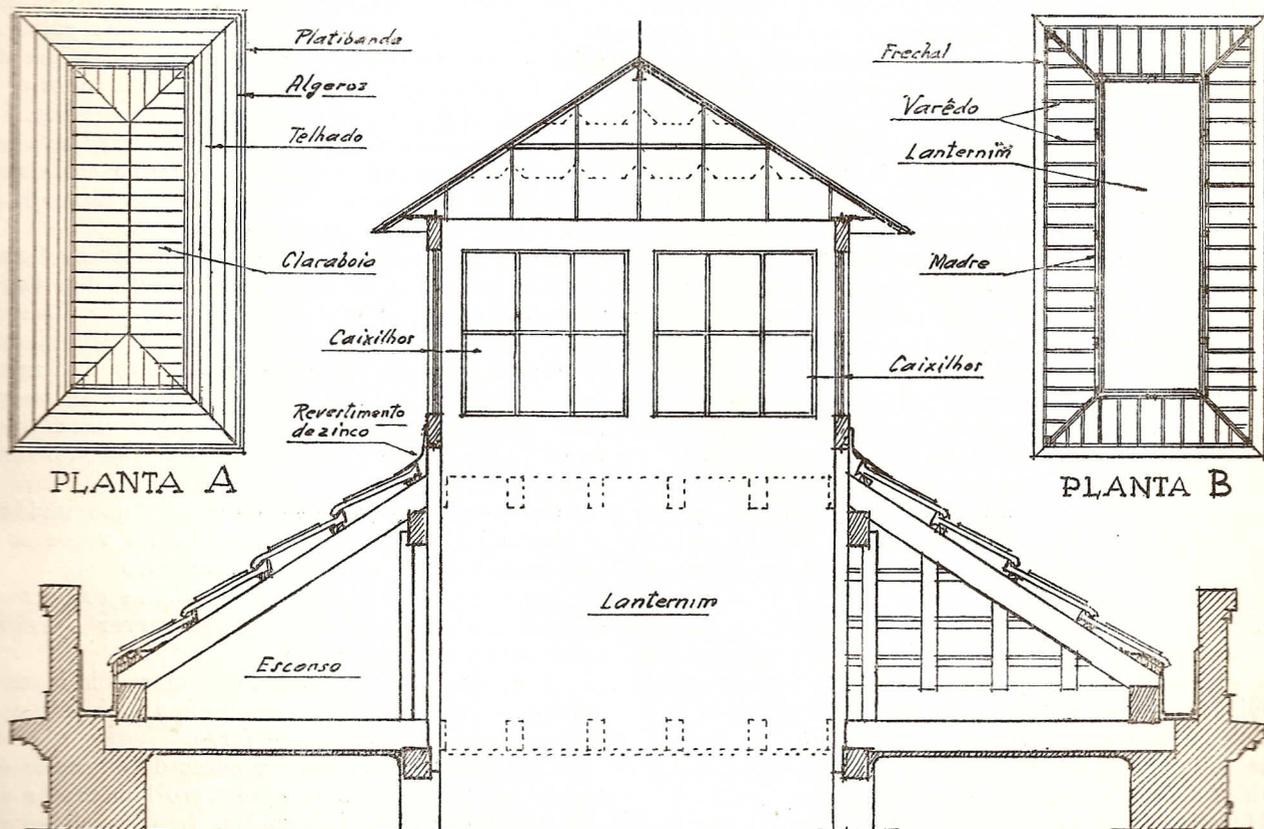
CORTE DE TELHADO COM LANTERNIM
